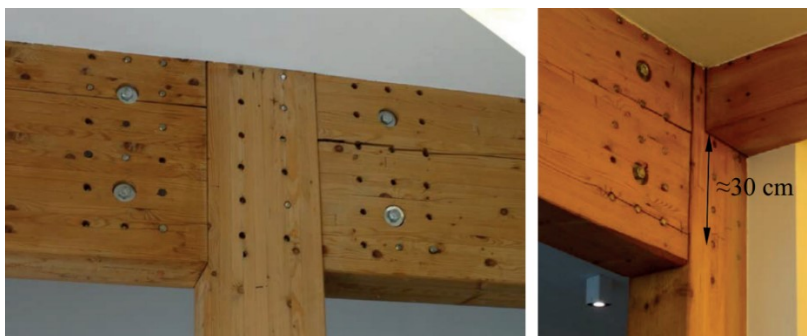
Fissuras devido a ligações rígidas em ambientes secos (Brunauer, 2017)
